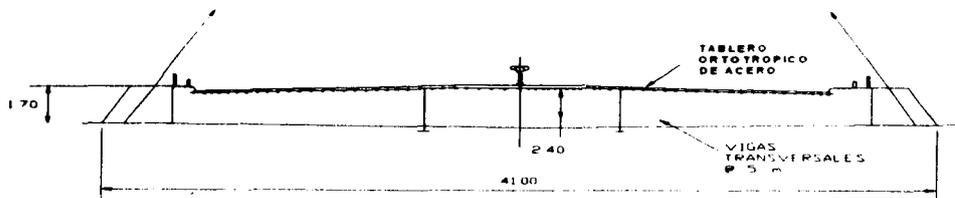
Sección transversal de un puente de acero muy ancho para claros superiores a los 500 m
